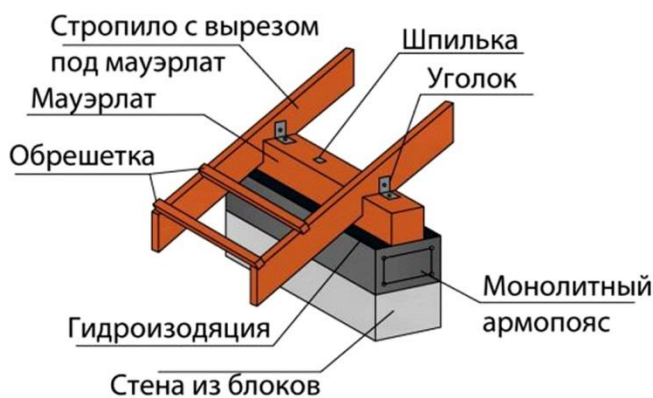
Узлы устройства карниза здания со скатной крышей по деревянным наслонным стропилам
